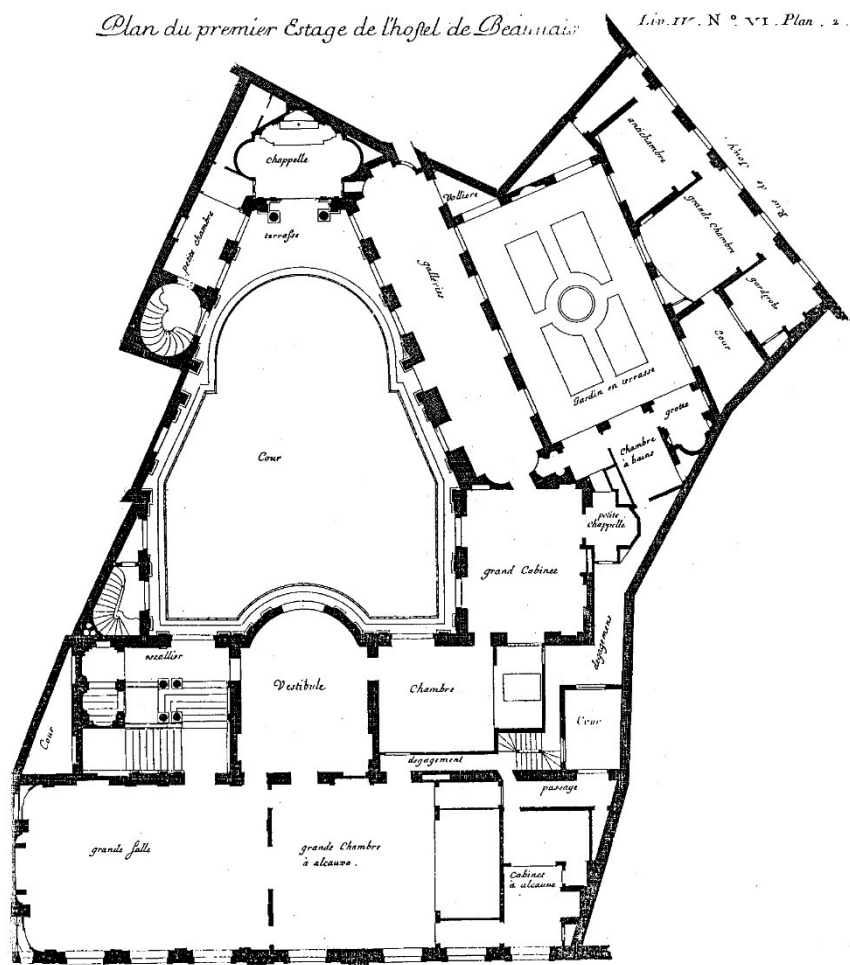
Planta del 1er piso del Hotel Beauvais, 1655. Arquitecto: Antoine Le Pautre.
